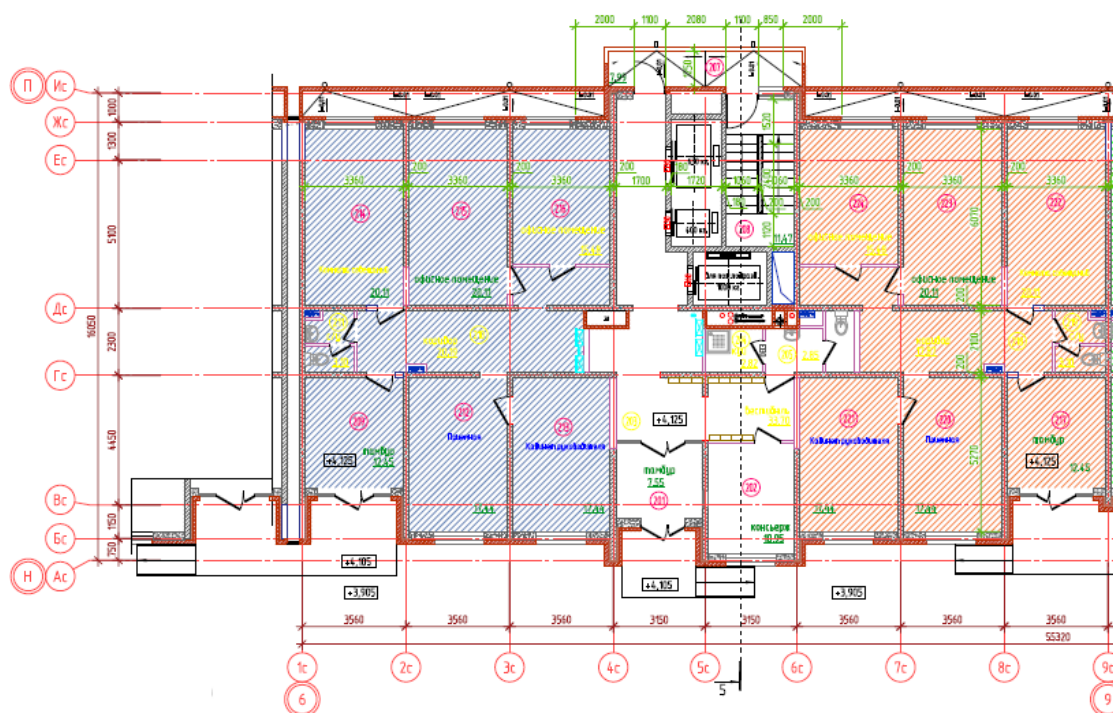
План 2 этажа БС-6 ЖК URAL
